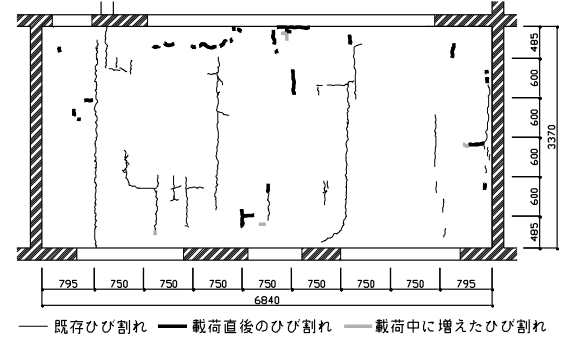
スラブ上面のひび割れ状況(工法2)
